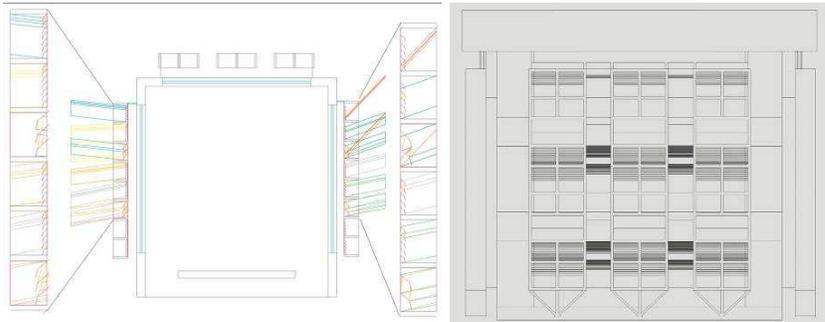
Diseño de elementos del sistema nuevo propuesto para E-O (Izq.) y vista de fachada Norte. Bloqueo total de directa y redirección al aula.
